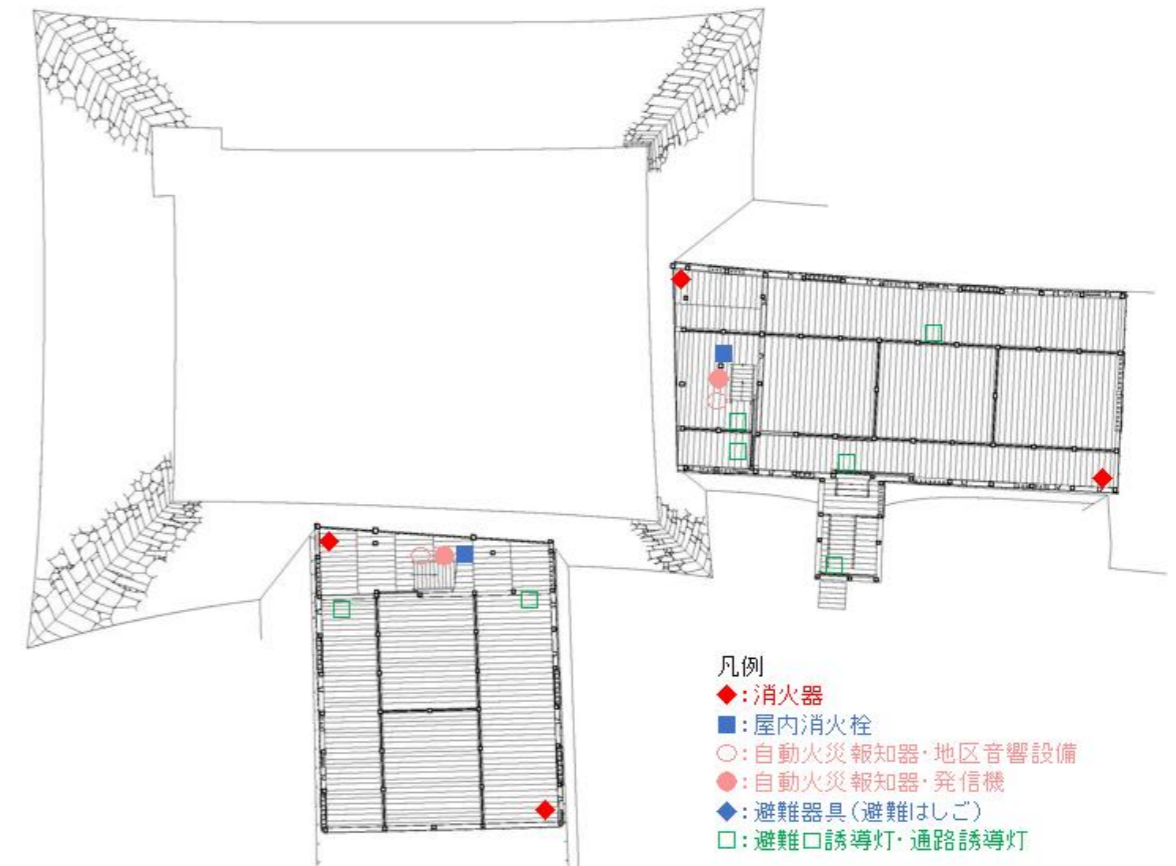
東廊下・南廊下 1 階平面図（復元原案）
